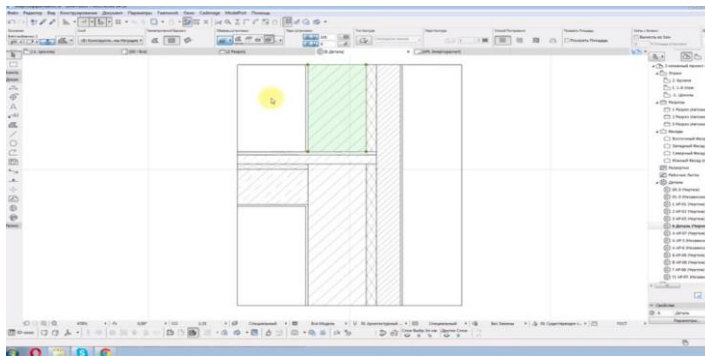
Вузол обпирання плити перекриття на стіну з керамоблоків
